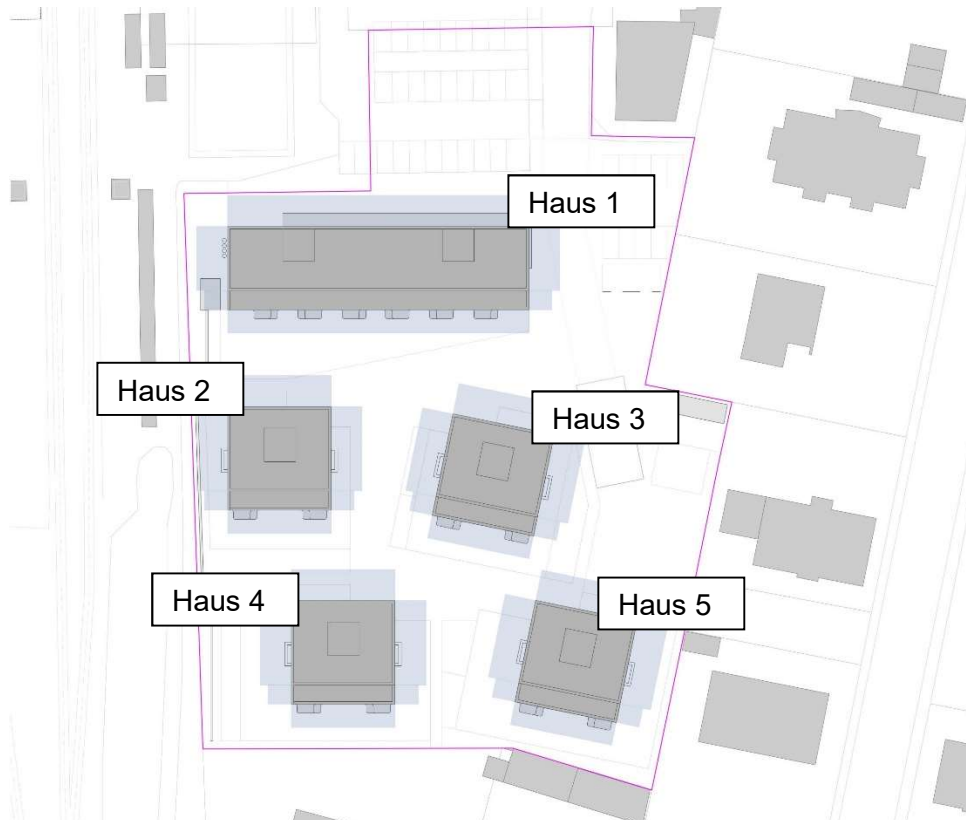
Planung für „Postareal“ vom 02.11.2021 [a], Lageplan mit Umgebung
